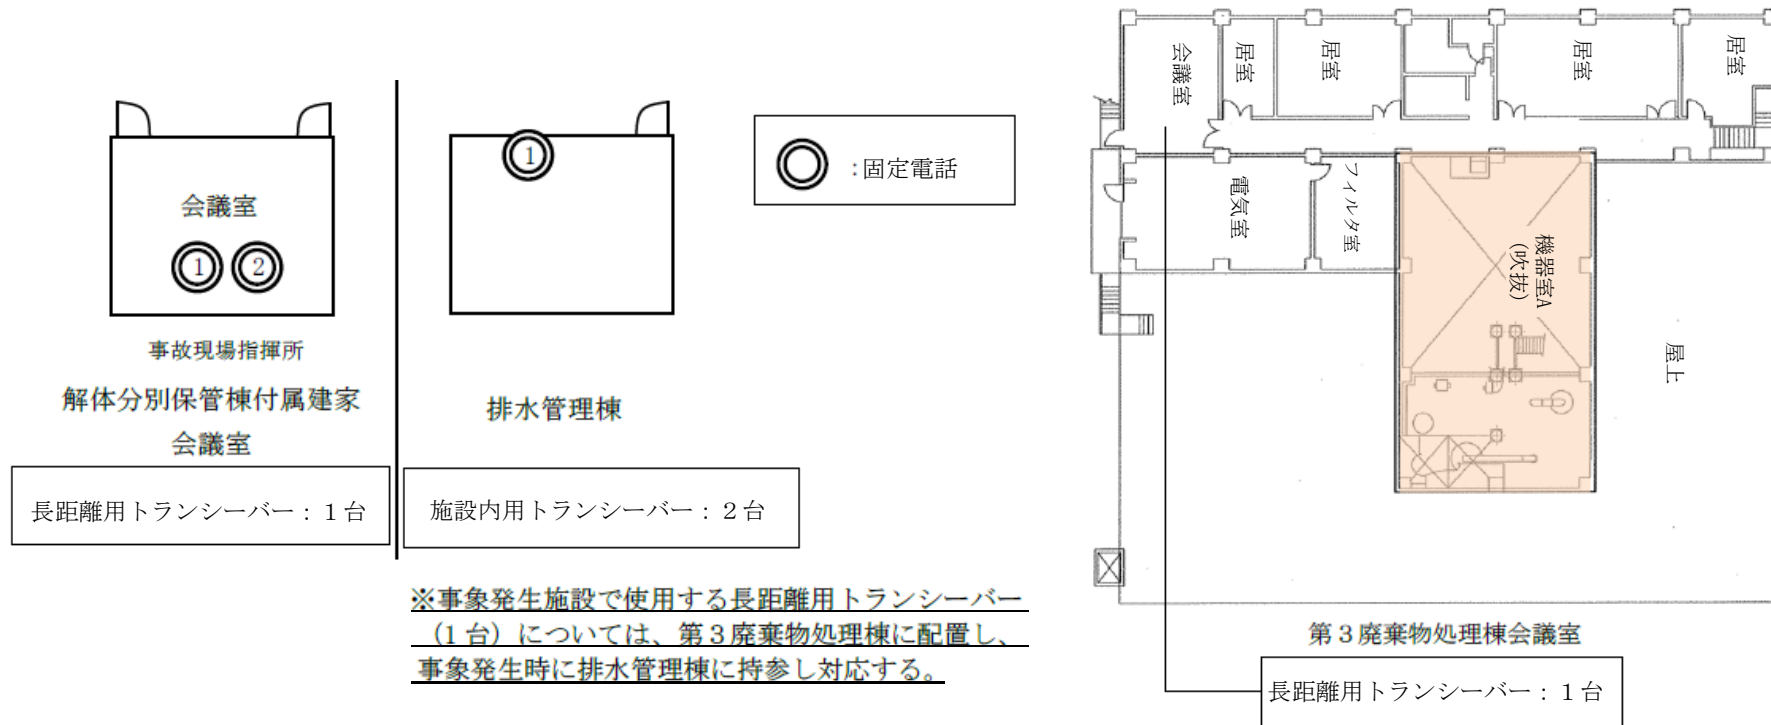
解体分別保管棟付属建家会議室(事故現場指揮所)及び排水管理棟並びに第3廃棄物処理棟の通信連絡設備の配置図
